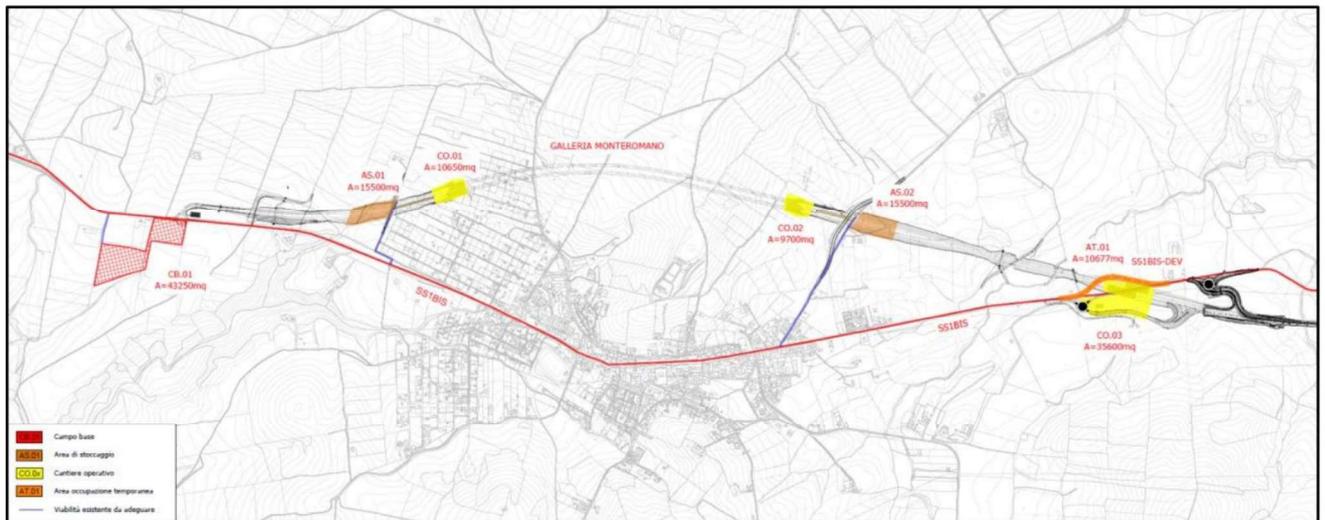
Planimetria d'insieme dell'ubicazione delle aree di cantiere con i rispettivi collegamenti viari T00IA01AMRE04\_A
